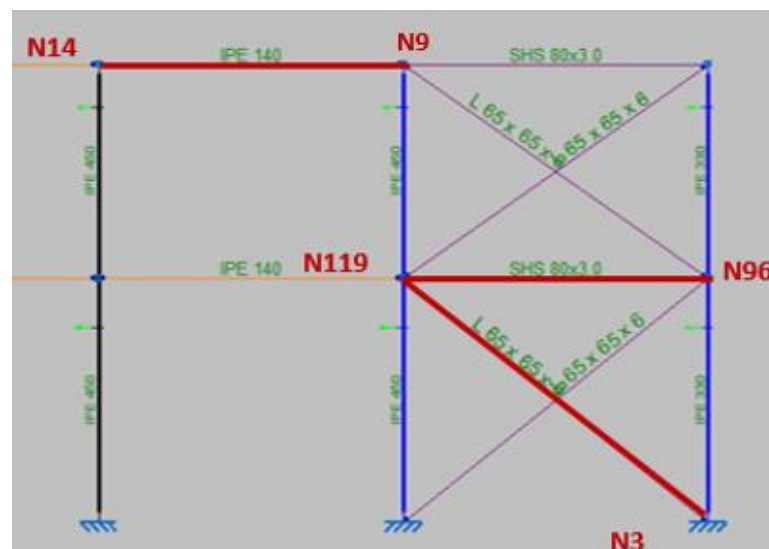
Sección fachada lateral. Selección de barras. (Fuente CYPE 3D).
